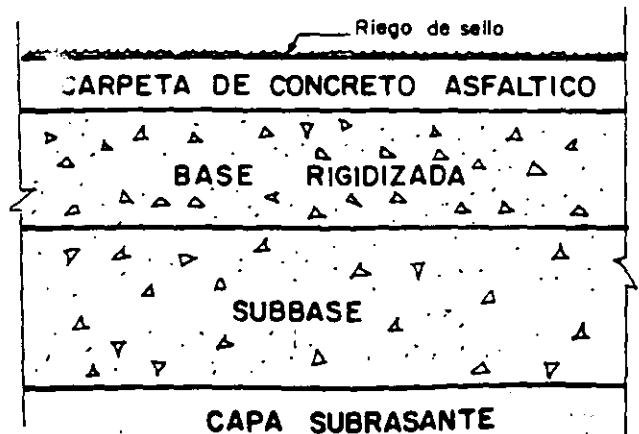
Capas que forman un pavimento flexible con carpeta de concreto asfáltico.
